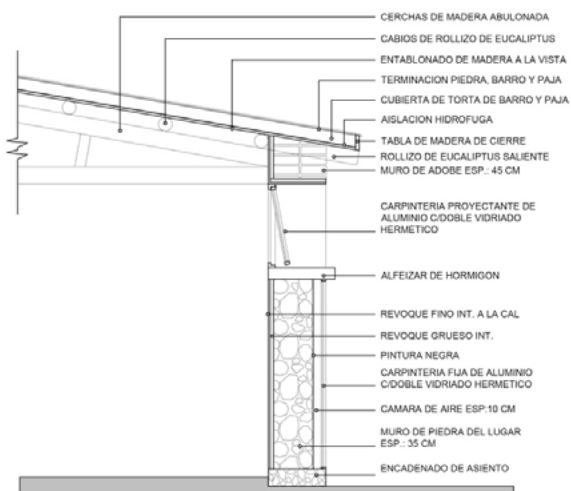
Detalle y sistema constructivo del Albergue El Alfarcito.
